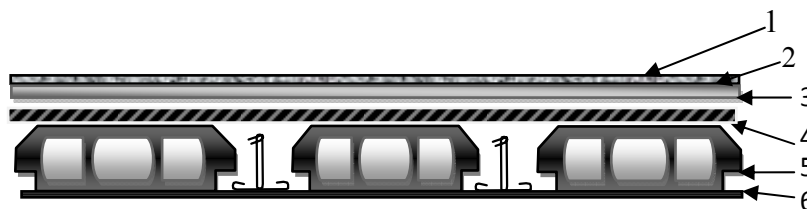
Coupe transversal de plancher de terrasse inaccessible.
